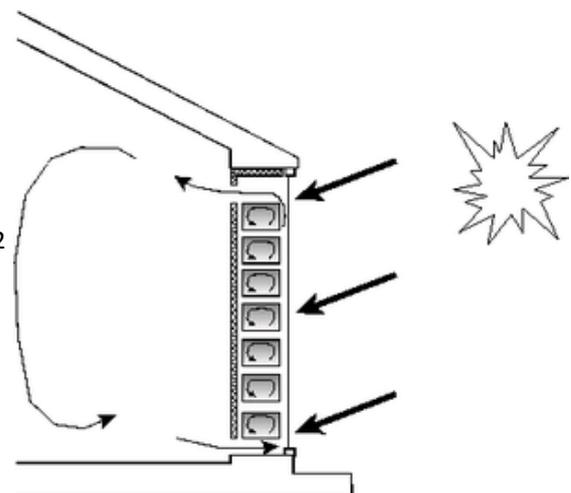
Esquema del muro de agua. Fuente: web 23
